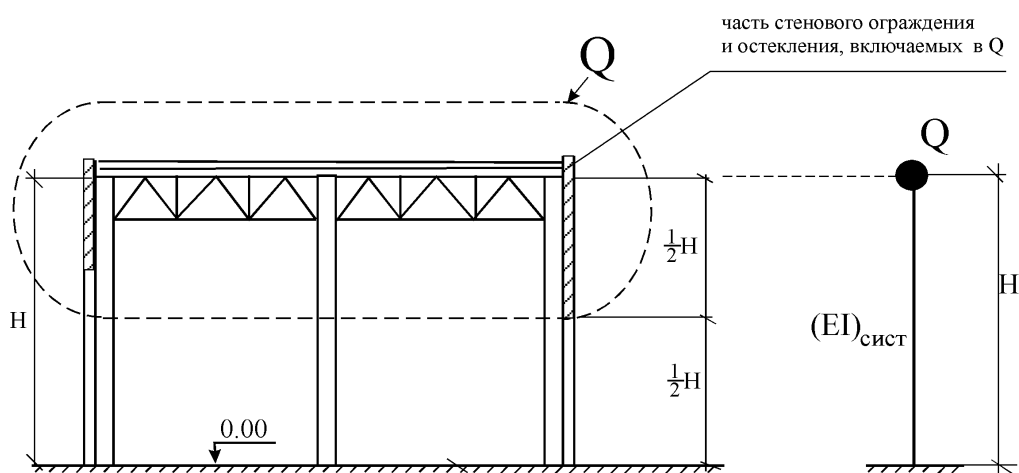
Формирование динамической расчетной схемы при жестком сопряжении стропильной конструкции с колоннами
